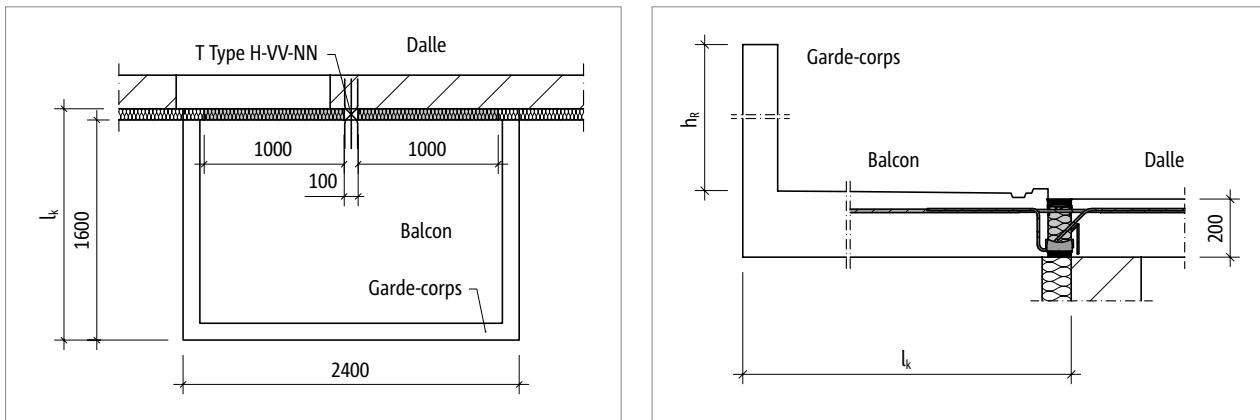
Schöck Isokorb® T type K-E, K-T avec Type T : Système statique, plan de base
